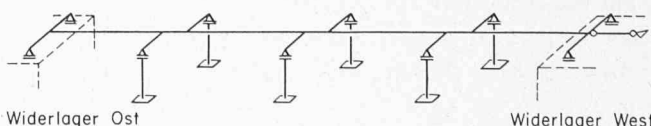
Das statische System, gültig für alle Belastungsannahmen
